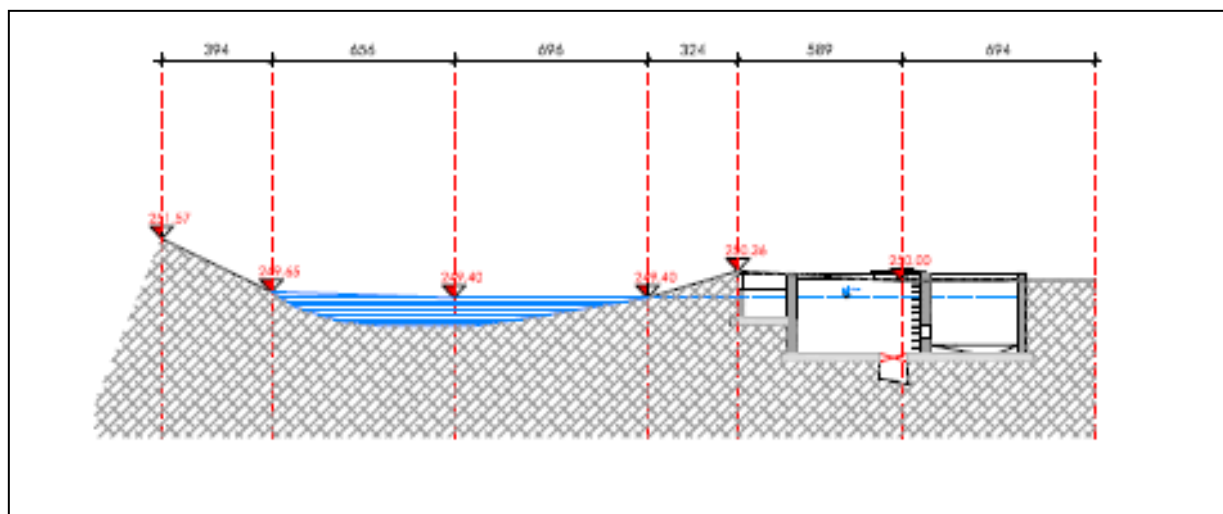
Sezione del locale centrale con vista a valle della briglia con il vano di alloggiamento della turbina e lo scarico di restituzione delle acque turbinate
